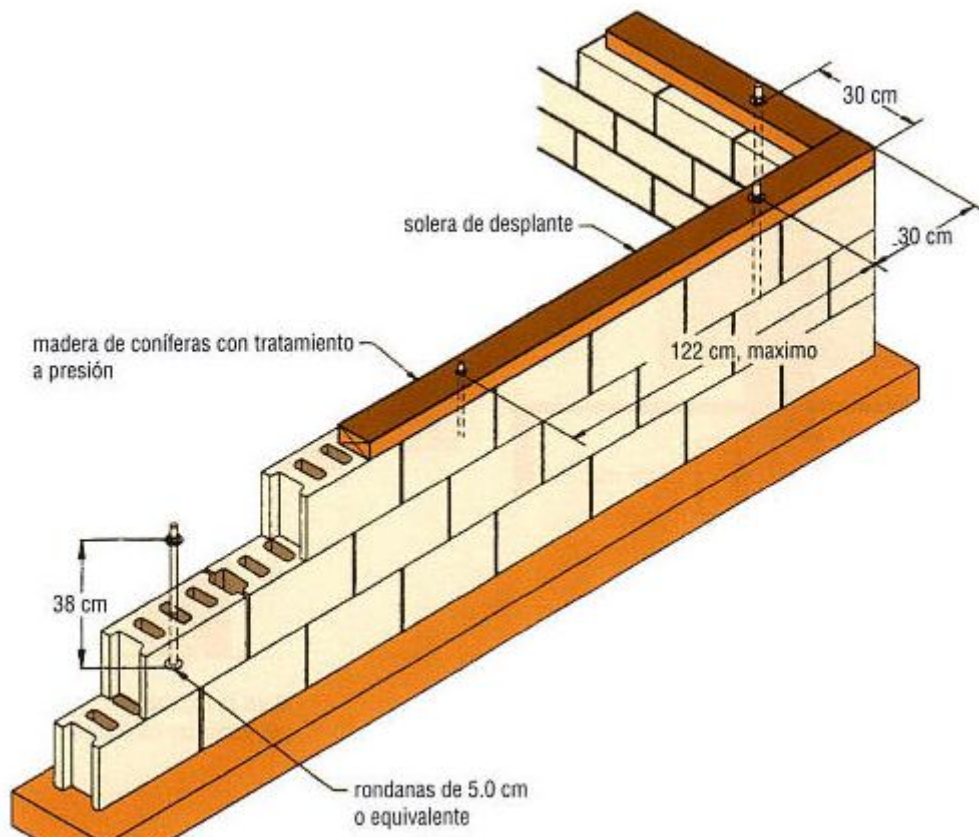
b) Ubicación de anclas en cimentación con bloques de concreto.
